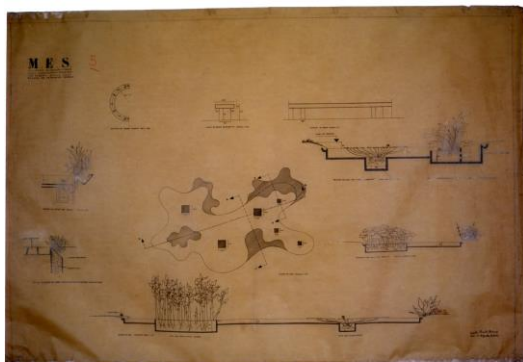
Proyecto original del MES (versión final) con detalles del lago en la planta baja.
